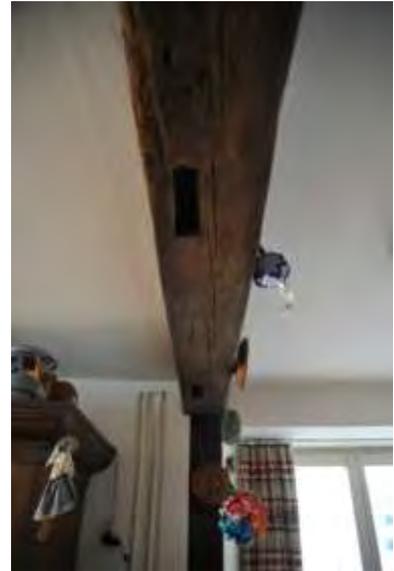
Küche 005 mit Nebenstube 004, das Holzgerüst zeigt Zapflöcher des ehemaligen Fachwerks. Die Hölzer entstammen dem Vorgängerbau von 1819. Blick nach Westen.
